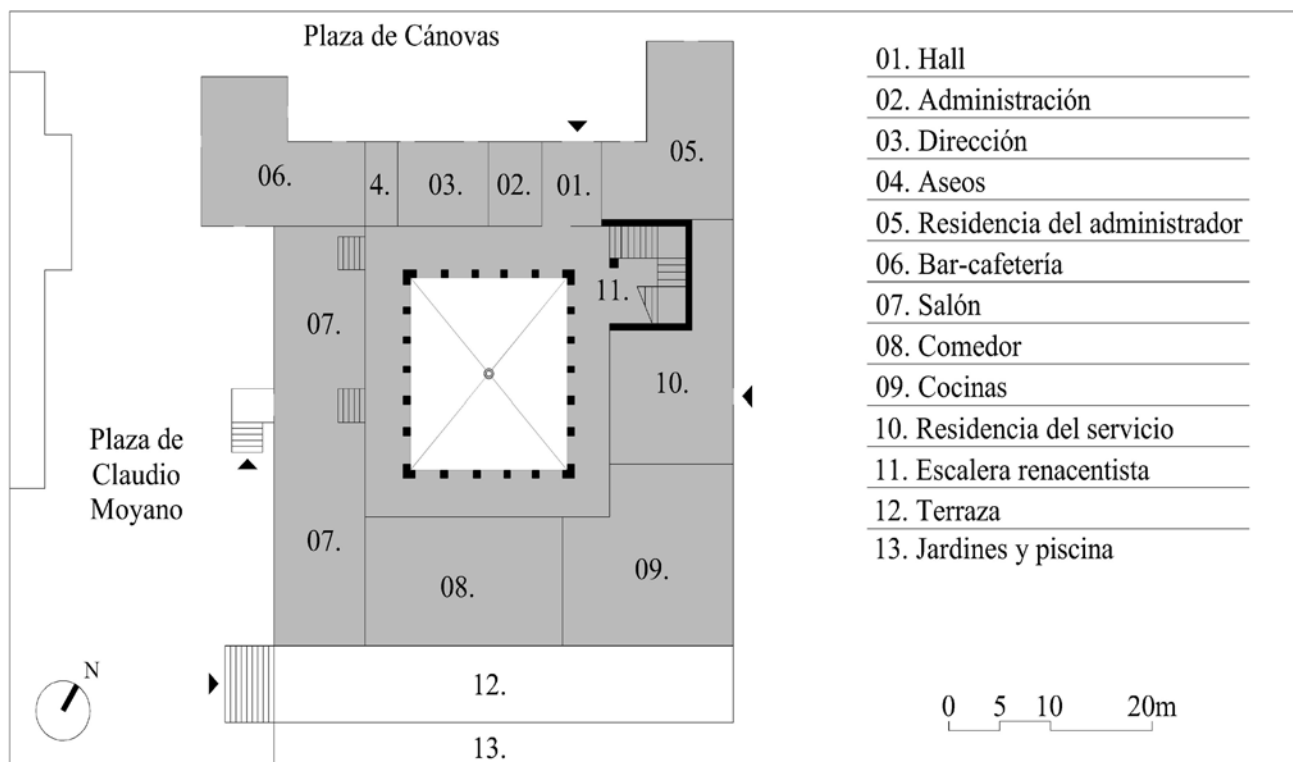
PLANTA BAJA DEL PROYECTO DEL PARADOR DE ZAMORA. (Elaboración propia basándose en el proyecto de 1965, AGA, MIT, 49-23, caja 46975).
